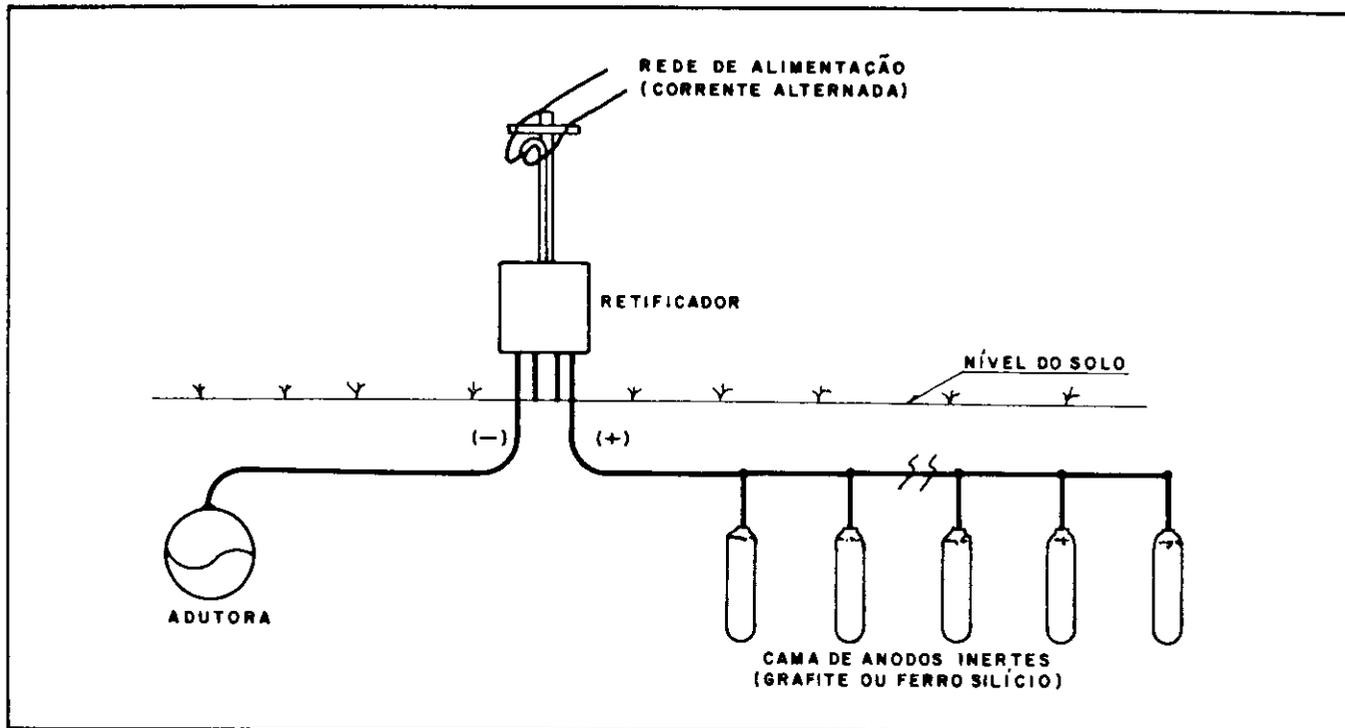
Esquema de instalação de um conjunto retificador/cama de anodos
